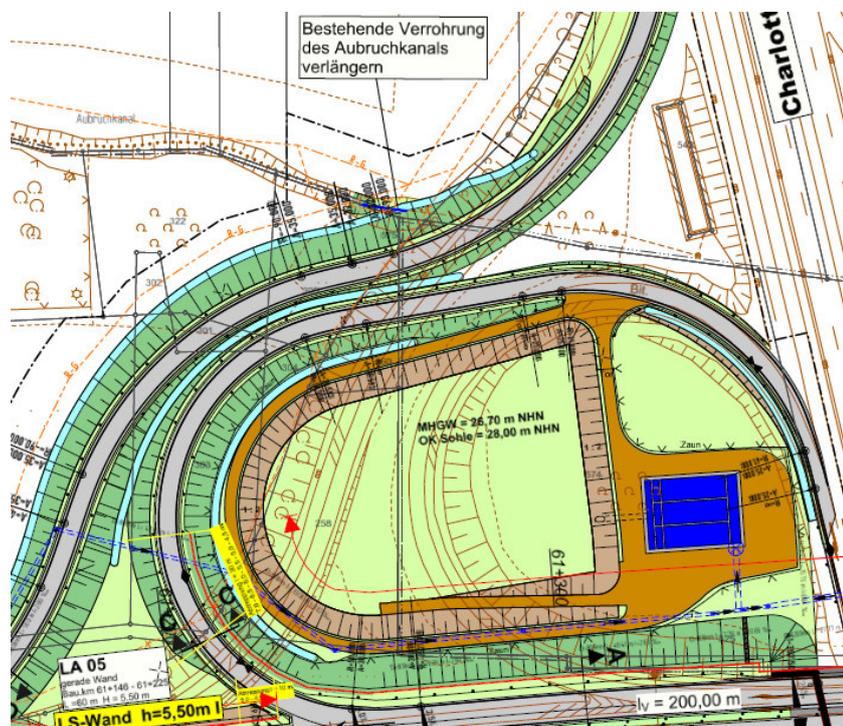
Lageplanausschnitt Regenwasserbehandlungsanlage Gartenstadt
